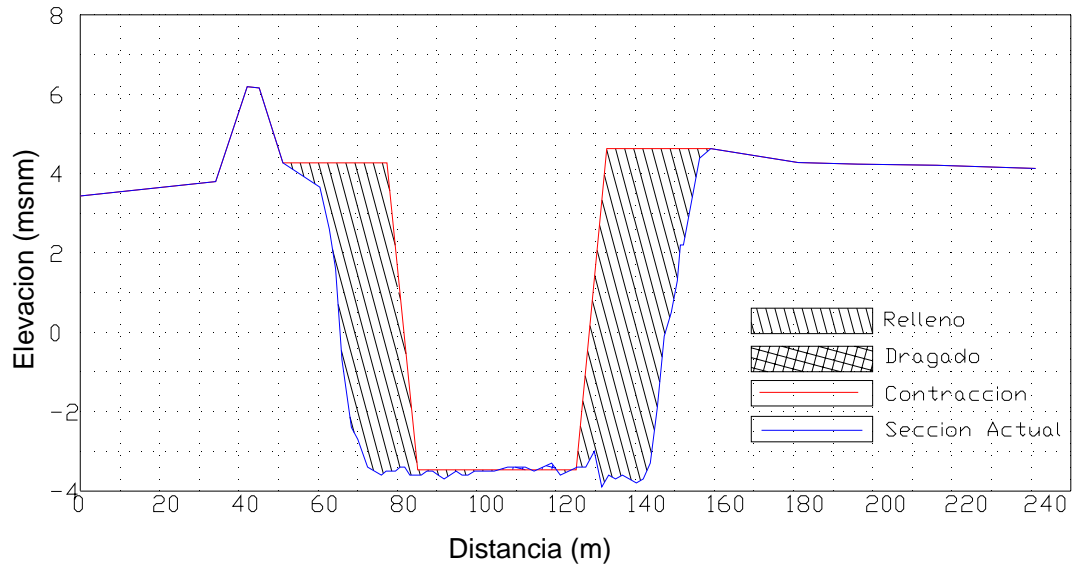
Sección transversal km 45 - Contracción No. 2
